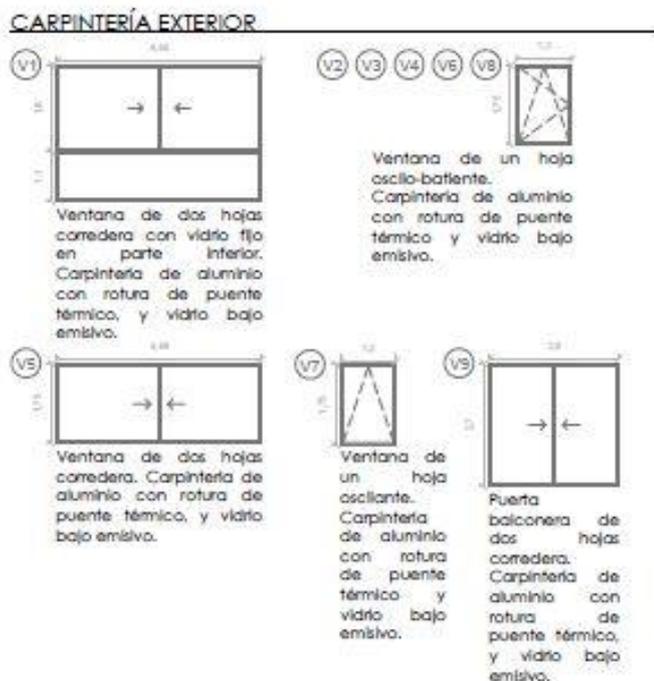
Definición de carpintería exterior de la vivienda. Elaboración propia.
